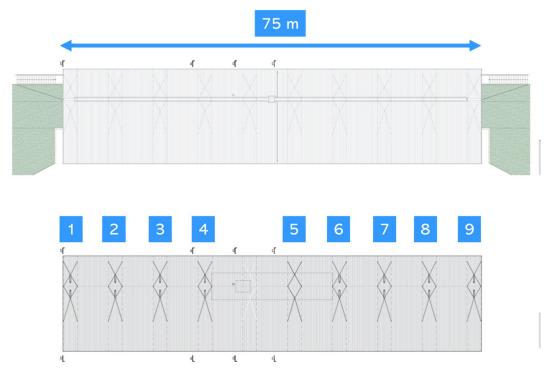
Fuente Elaboración propia, Planta de techos: Bathélémy Griño⁴²
